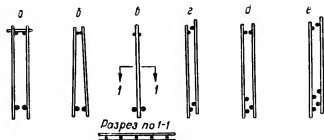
Сдвоенные сварные каркасы.
